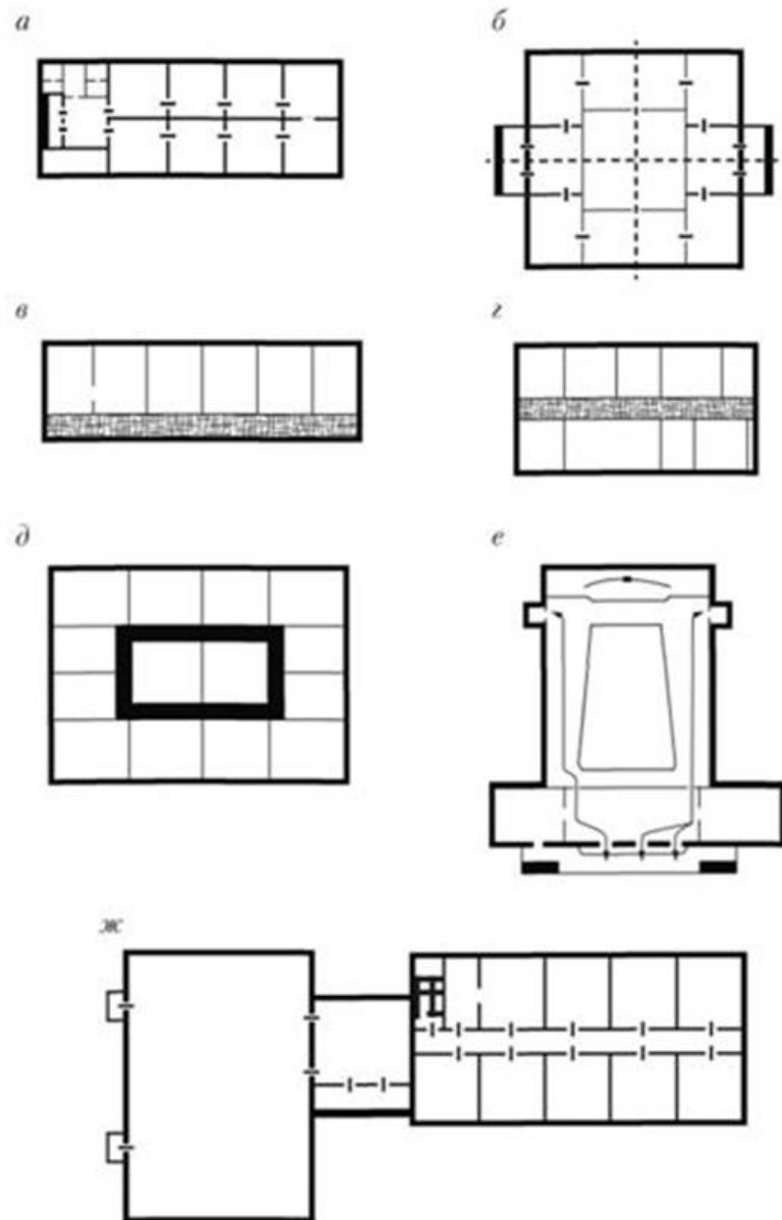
Об’ємно-планувальні схеми громадських будівель
